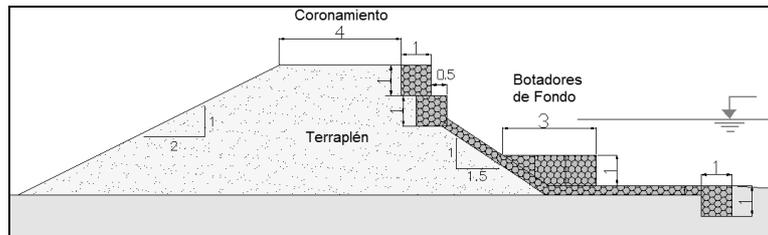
Sección transversal de la Protección Continua con botador de fondo cada 10 m.
